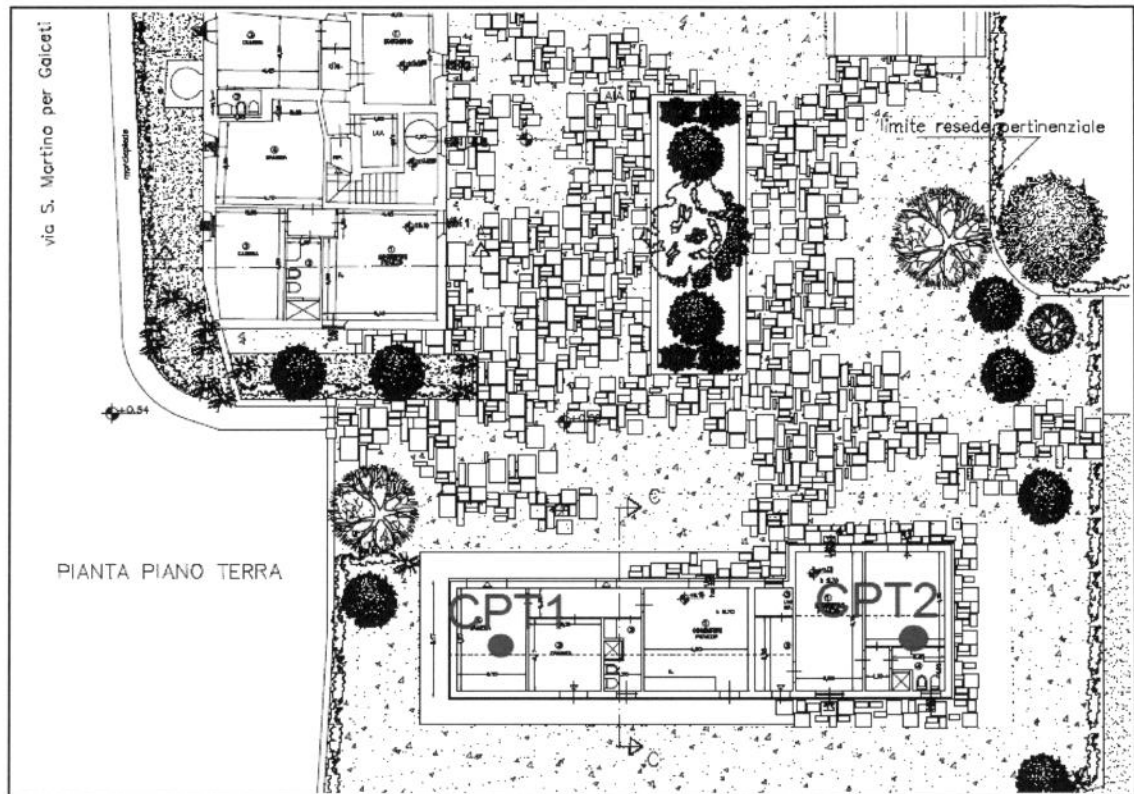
Ubicazione delle prove penetrometriche statiche.
